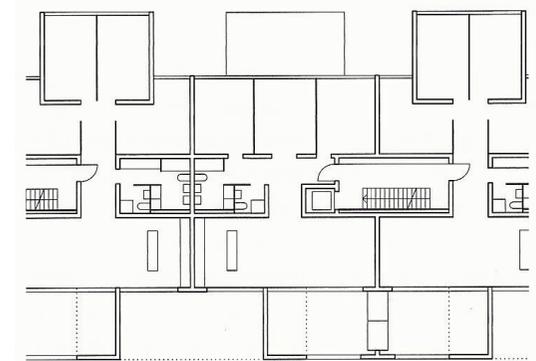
Wohnhaus Paul- Clairmont- Straße in Zürich- Wiedikon, Jakob Steib und Patrick Gmür, 2005. Grundriss Normalgeschoss
